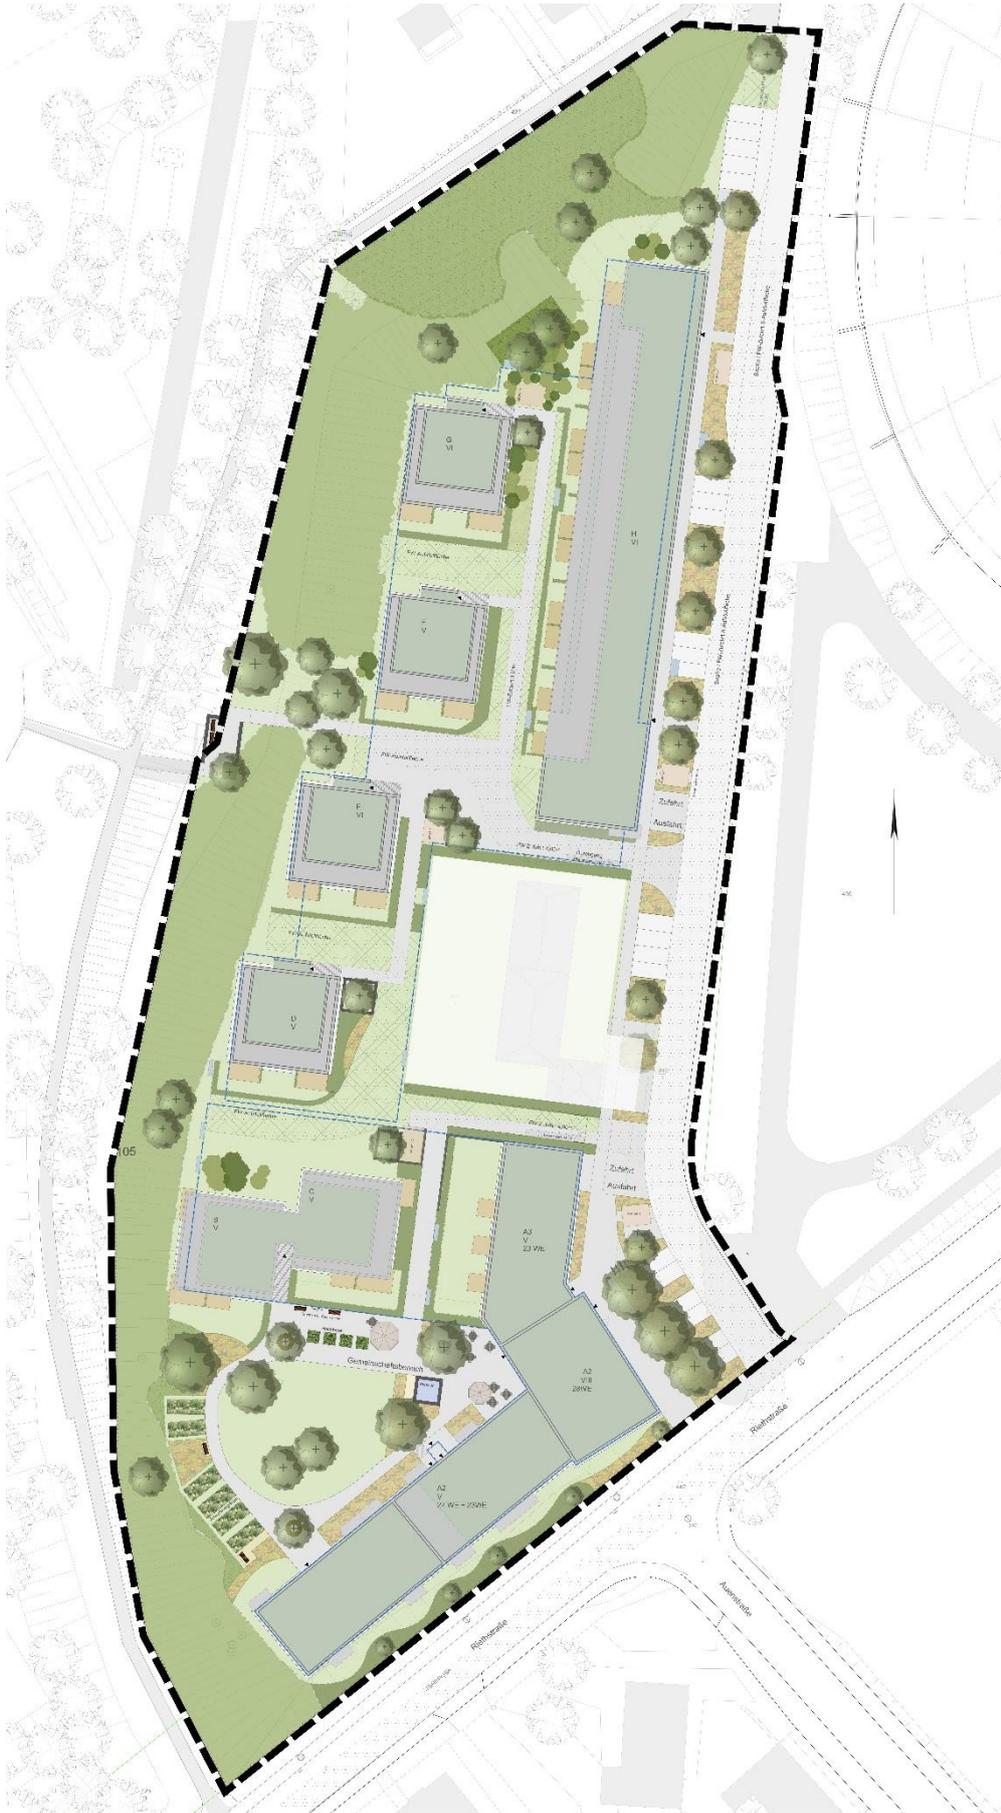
Entwurf Freianlagenplan zum VE-Plan
